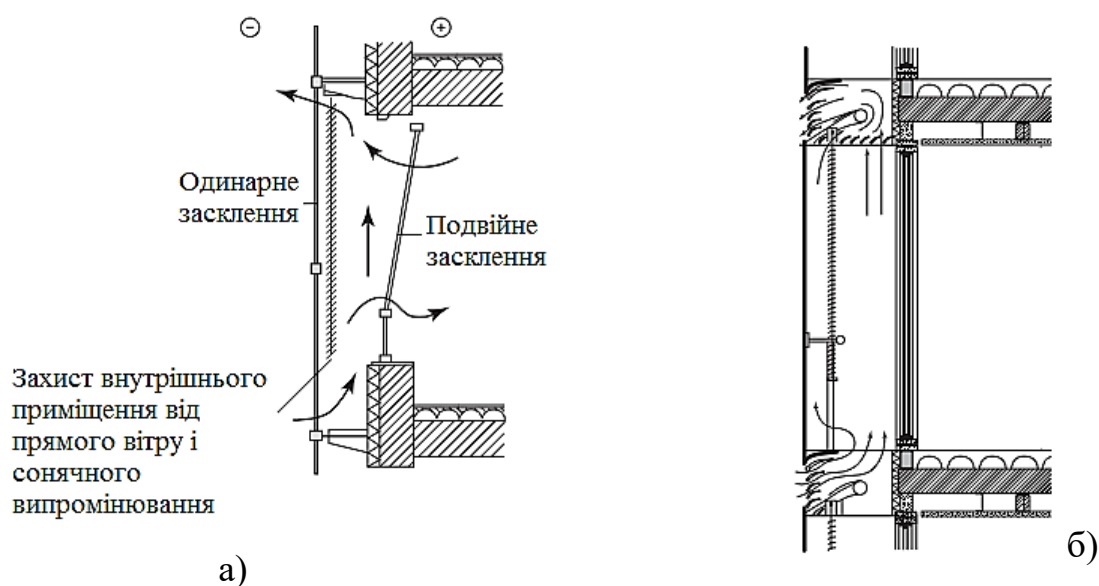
Схематичне зображення конструкції подвійного фасаду:
